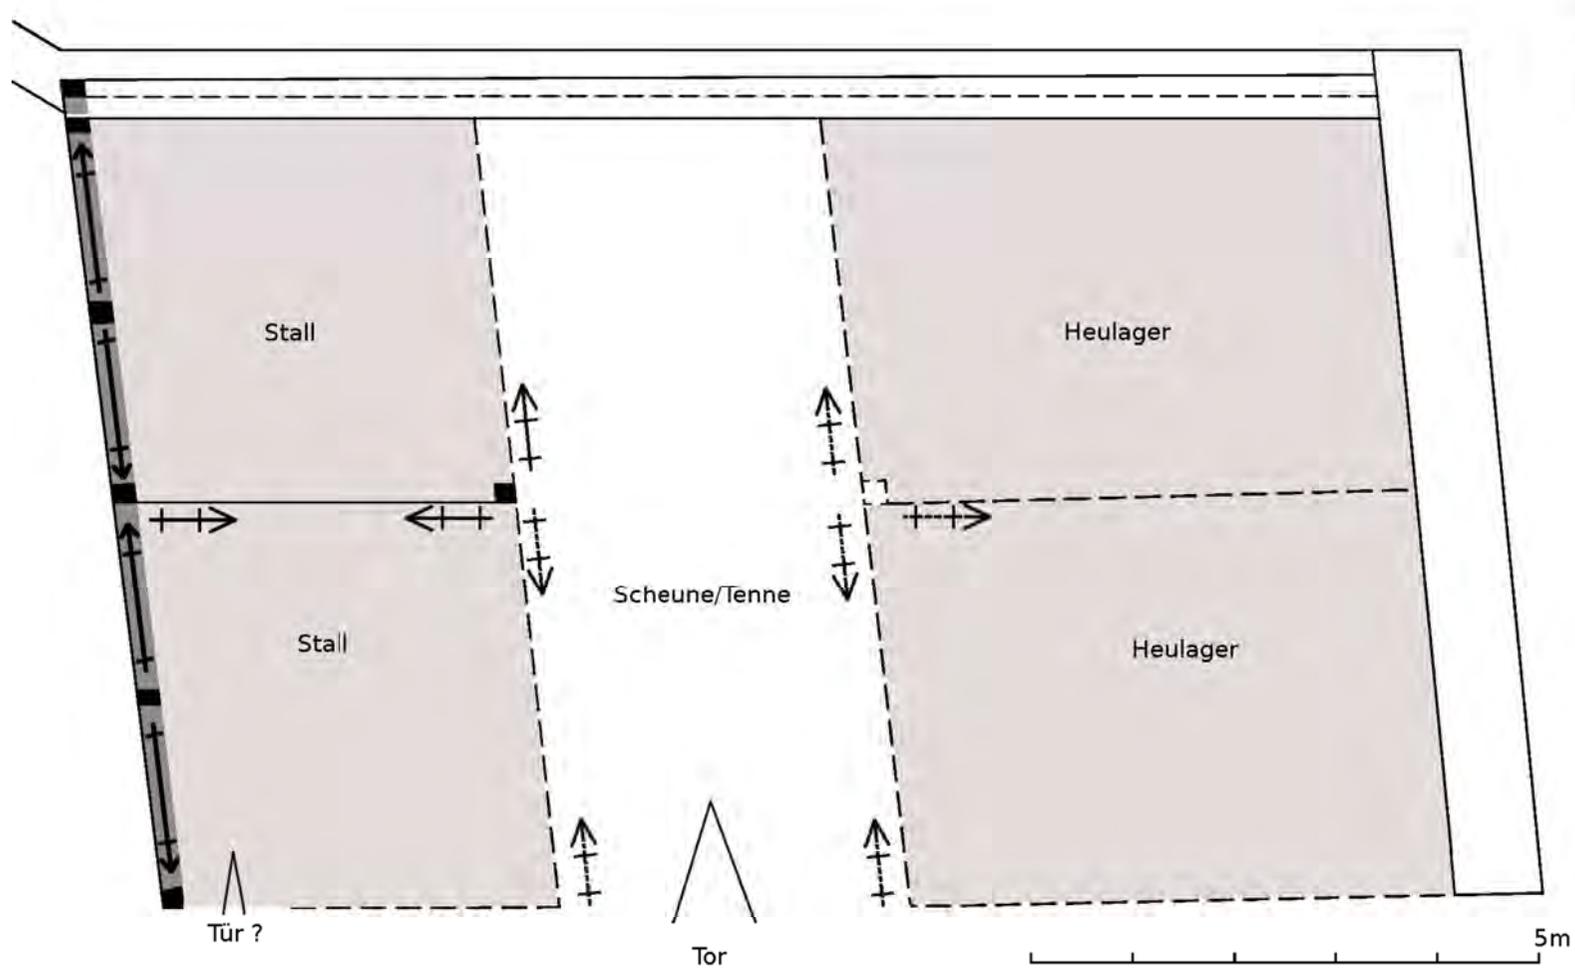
Freiburg, Markgrafenstraße 16a, sog. Melanchthonscheune, Systemgrundriss Erdgeschoss
